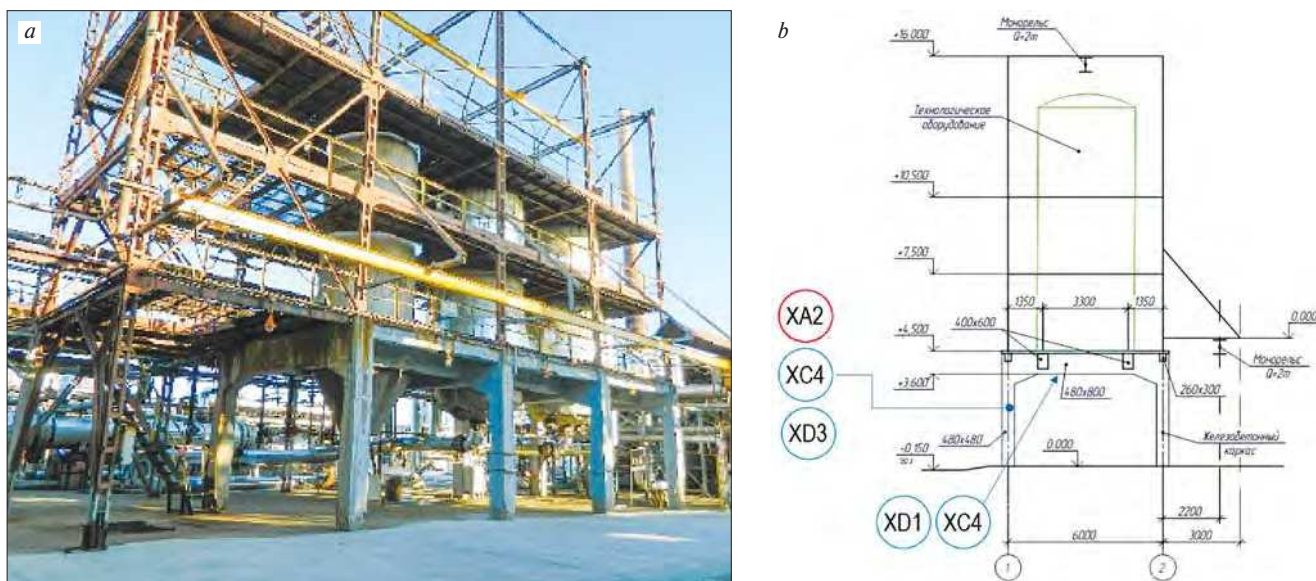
Технологическая этажерка: *a* – общий вид этажерки; *b* – разрез с индексацией условий агрессивной среды для бетона и железобетона по СП 28.13330.2017 «Защита строительных конструкций от коррозии»
